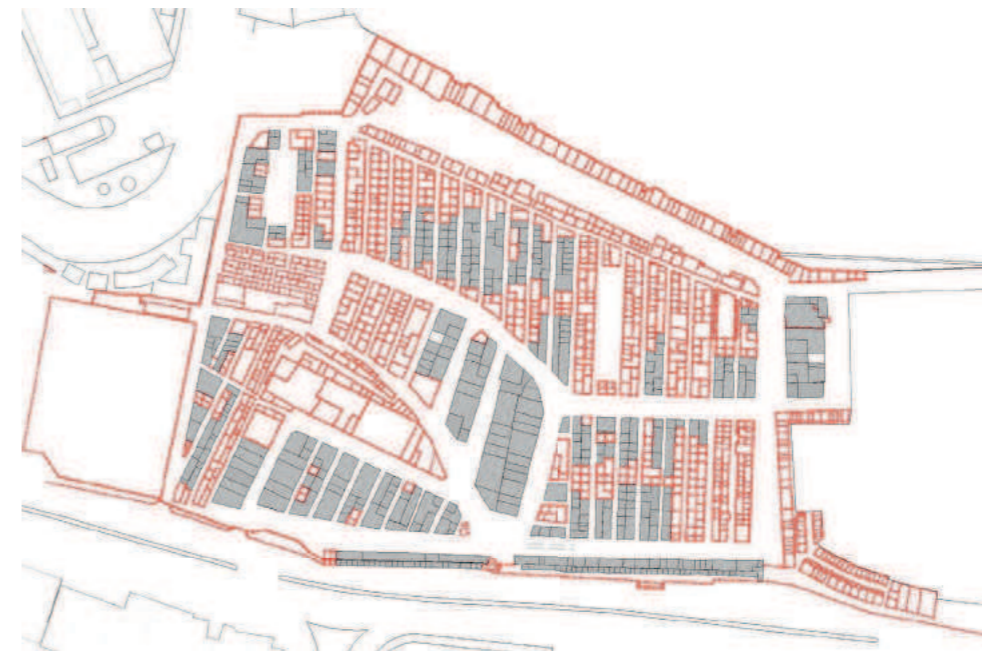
Planta baixa térrea. Fonte | Projeto Conder. Adaptado pela autora, 2023.
